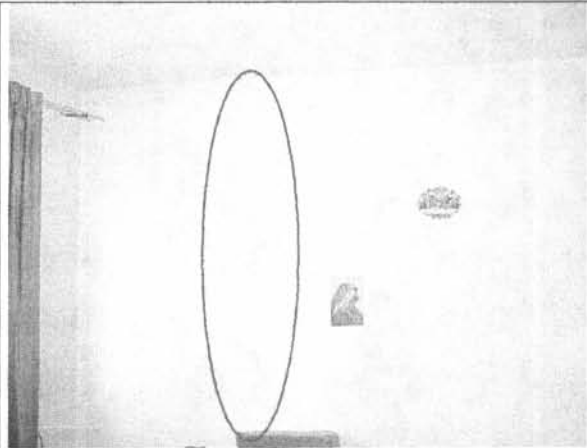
Fisuras en los muros de la sala -Piso 2
